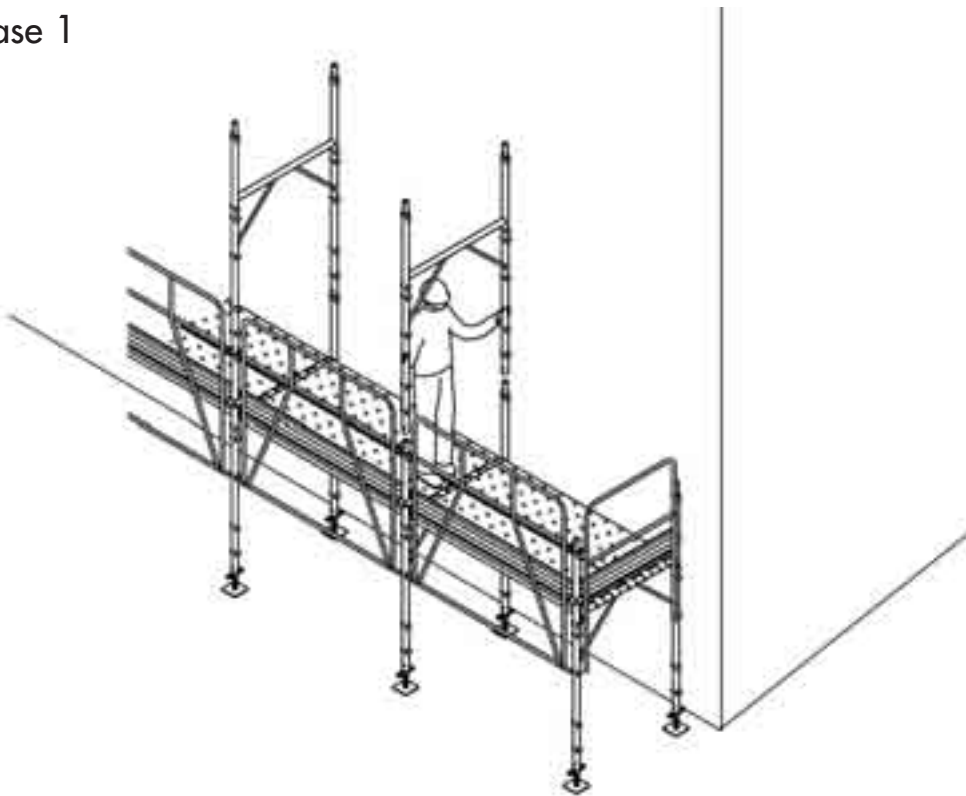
Esempio di ponteggi a telai con parapetto di protezione collettiva
